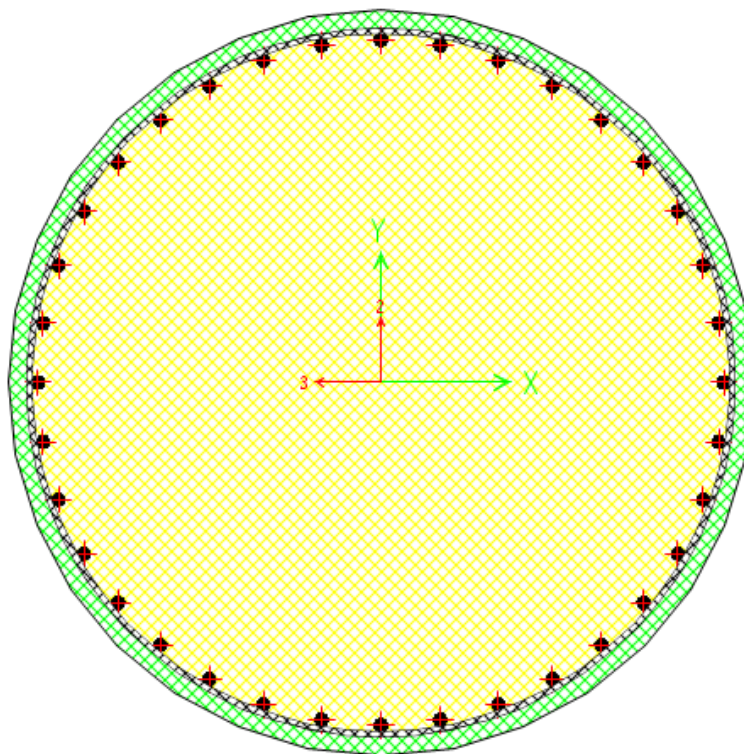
Columna de los pilares 1 y 3 (Fuente: elaboración propia)
